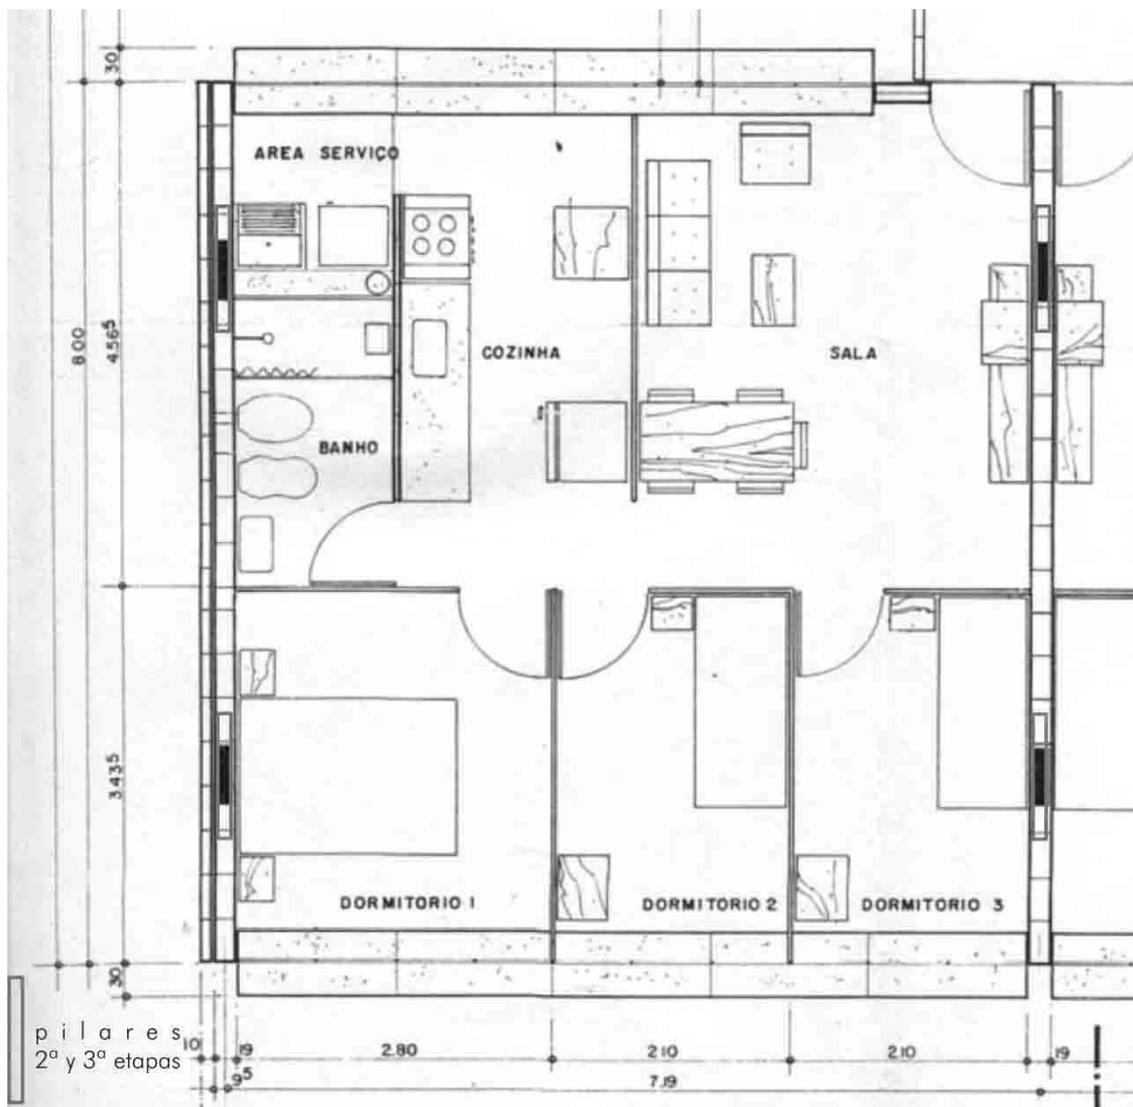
Planta del piso tipo (Fuente: <sup>13</sup>)
